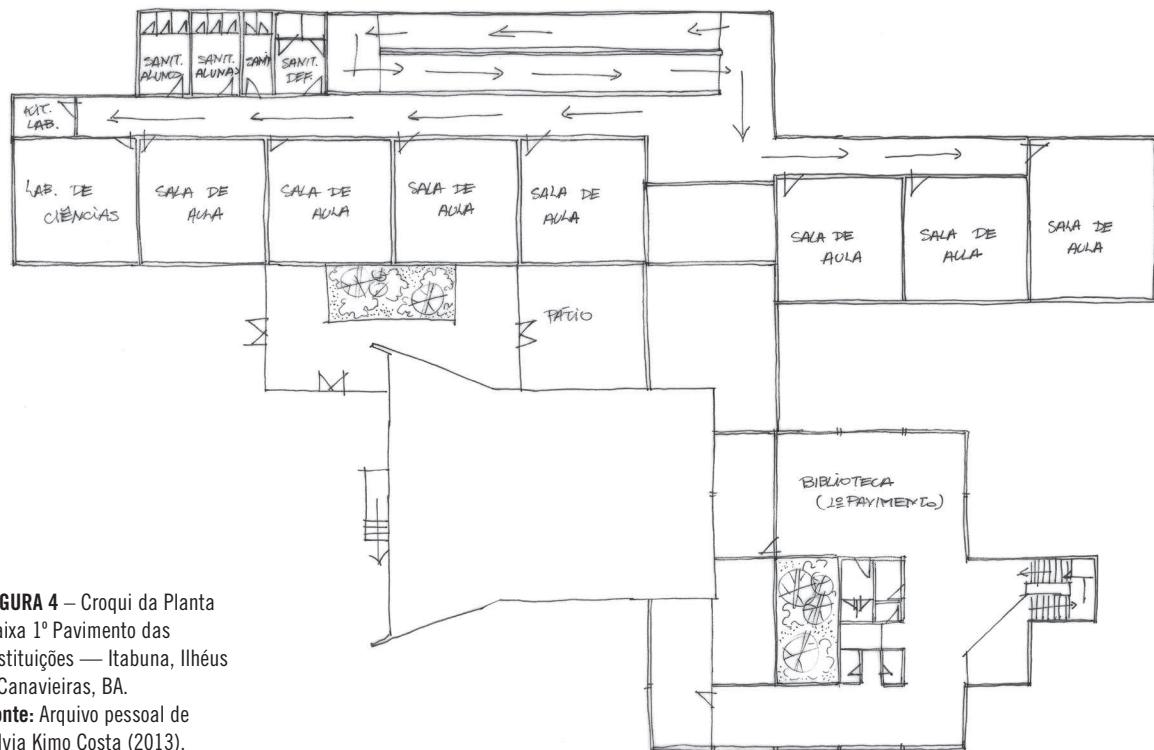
Croqui da Planta Baixa 1º Pavimento das Instituições — Itabuna, Ilhéus e Canavieiras, BA.
